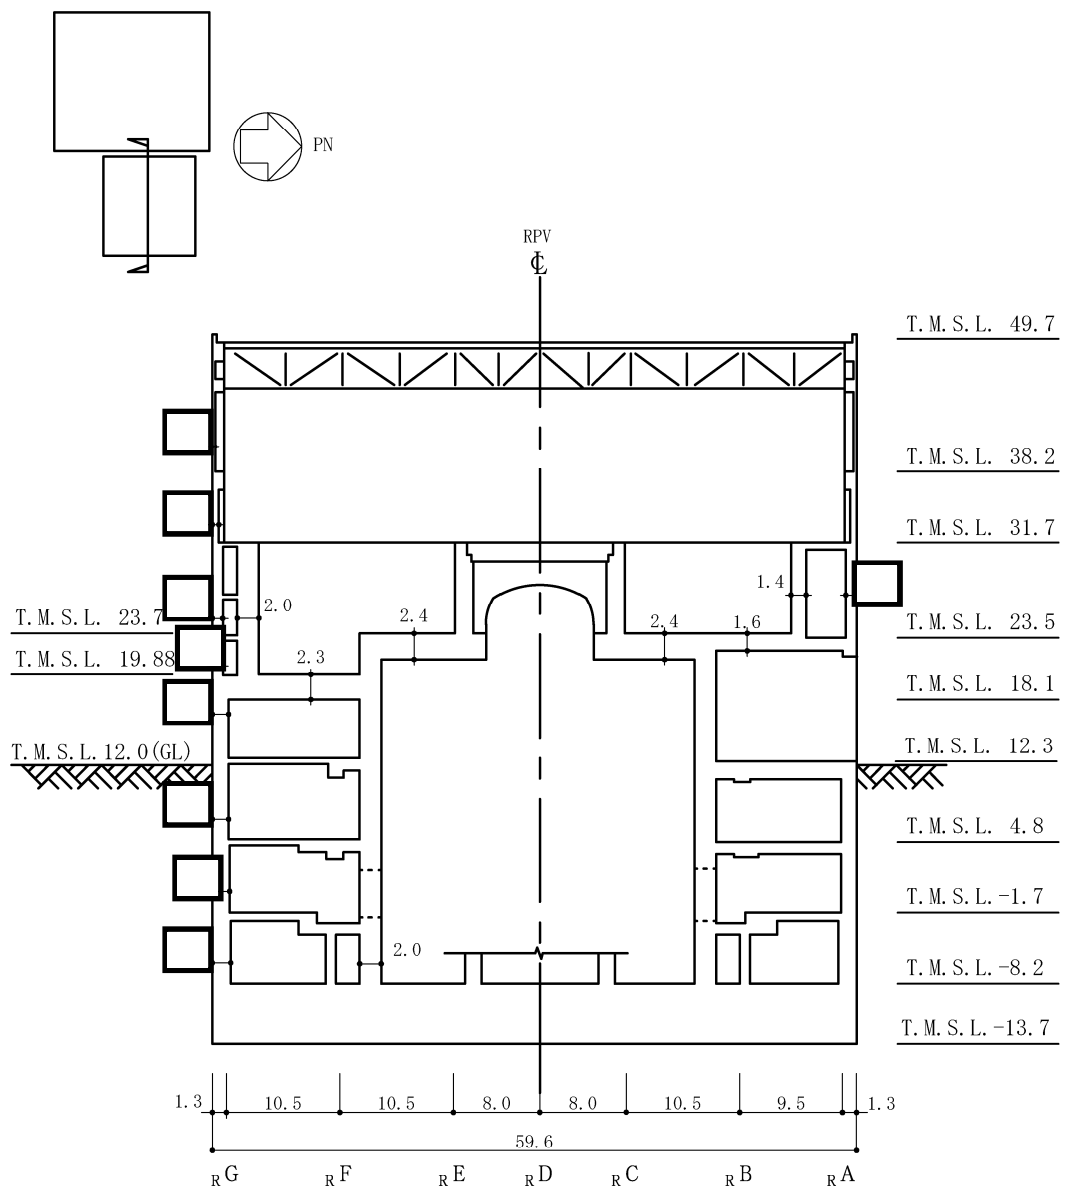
原子炉建屋の概略断面図 (EW方向) (2/2) (単位 : m)
